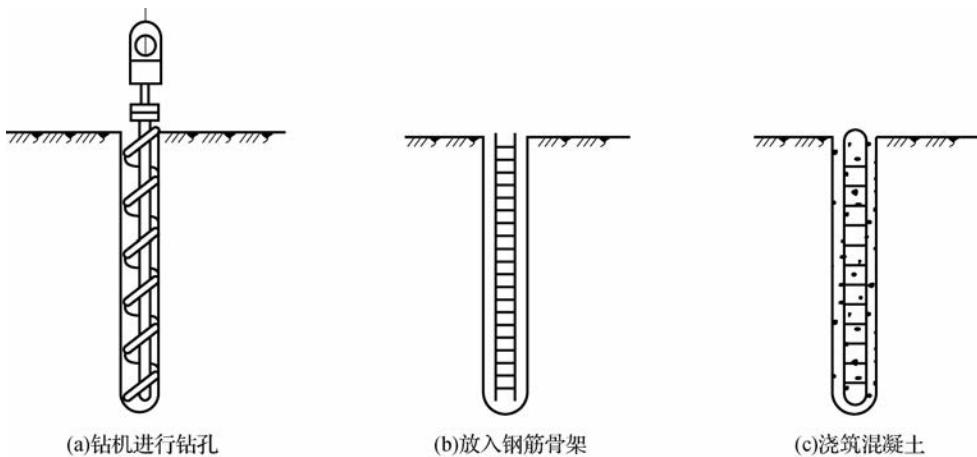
螺旋钻机钻孔灌注桩施工过程示意图
